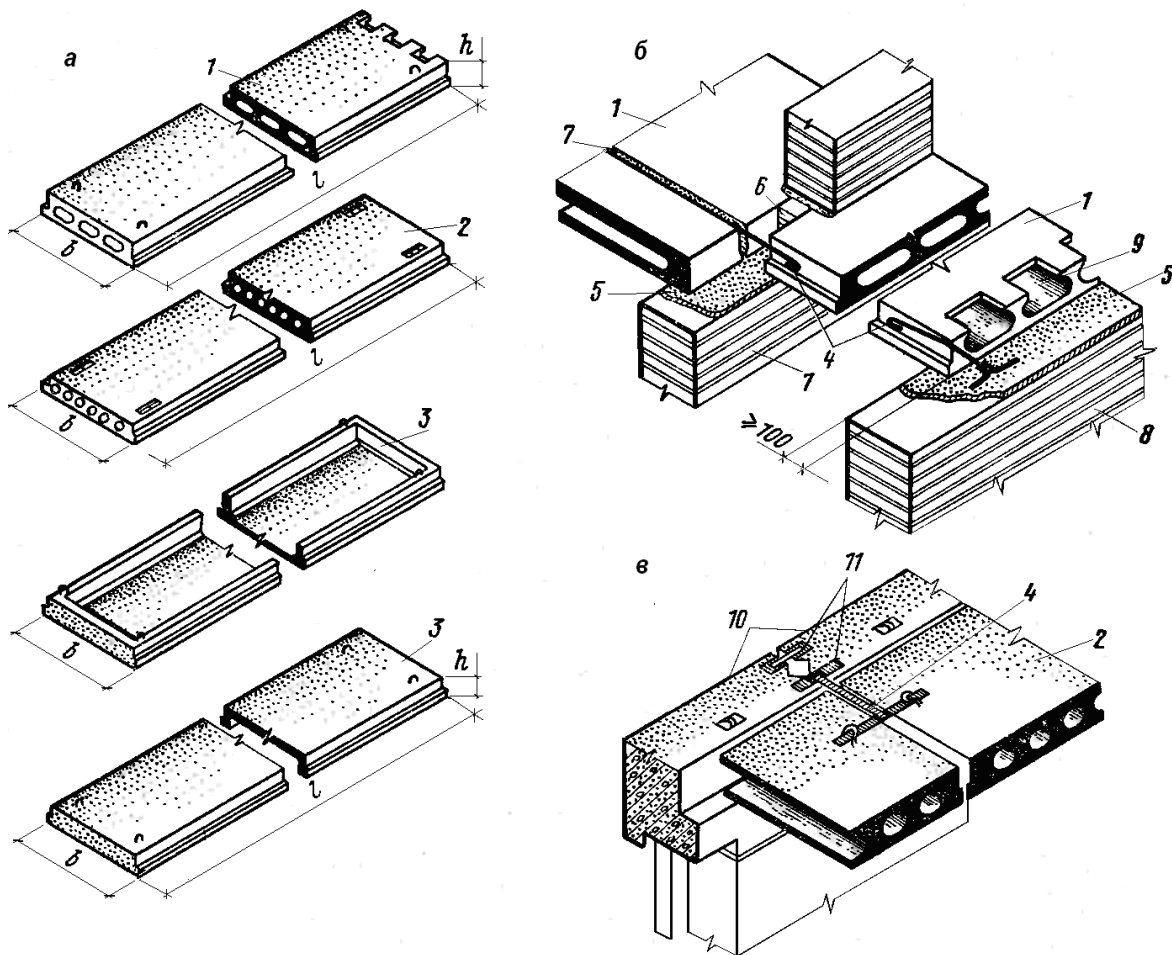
Збірні перекриття із плит: а – типи залізобетонних плит; б – спирання і закріплення плит в цегляній будівлі; в – теж, в крупноблочному; 1 – плити з овальними пустотами; 2 – плити з круглими пустотами; 3 – ребристі плити; 4 – анкер; 5 – розчин; 6 – кладка; 7 – внутрішня стіна; 8 – зовнішня стіна; 9 – вирізи (заповнюються кладкою або бетонними вкладками); 10 – блоки-перемички; 11 – закладні деталі
